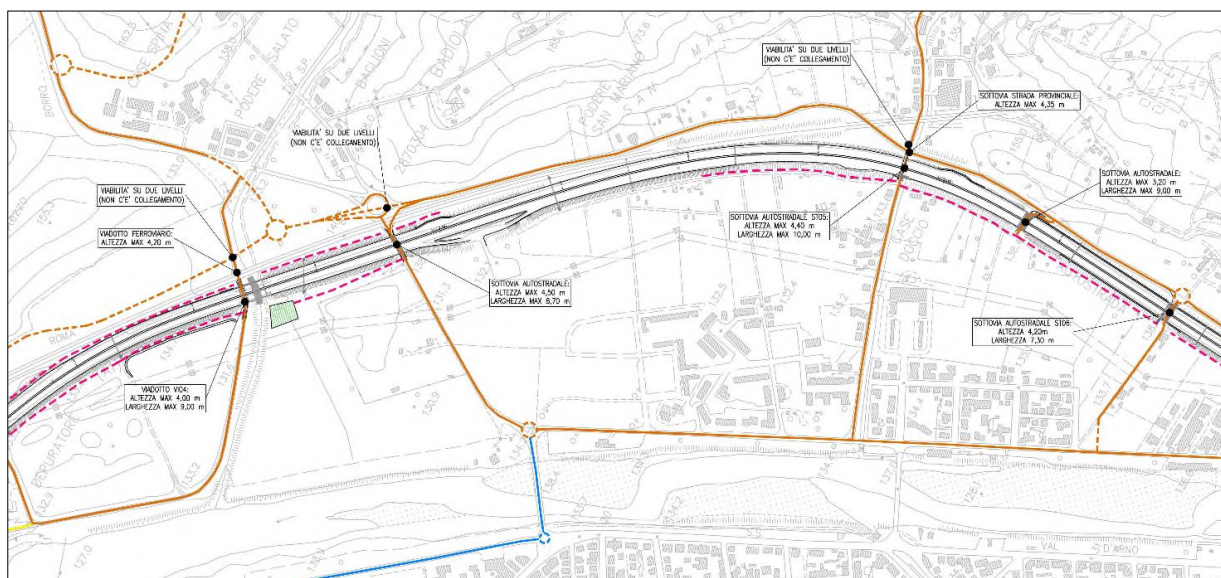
Lotto 2: stralcio esemplificativo da CAP202 del sistema viario di cantiere nel tratto lungo rilevato
